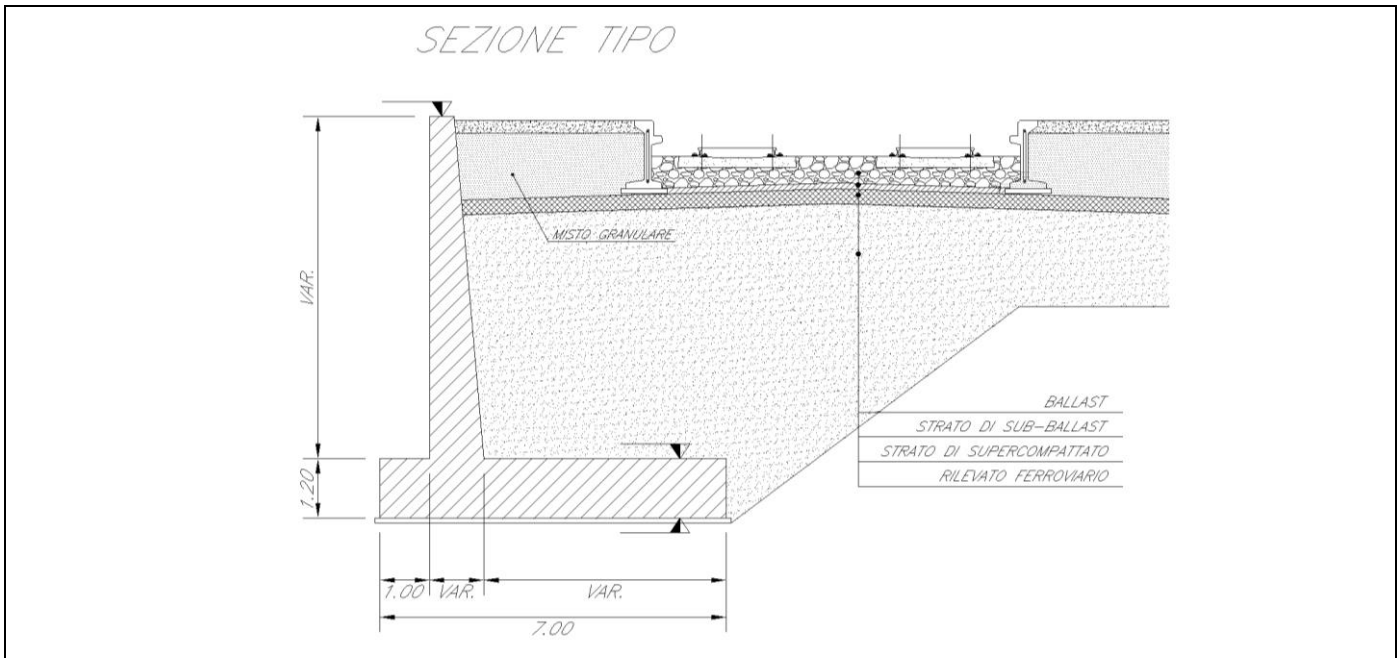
Sezione trasversale tipica conci da 8 a 10
